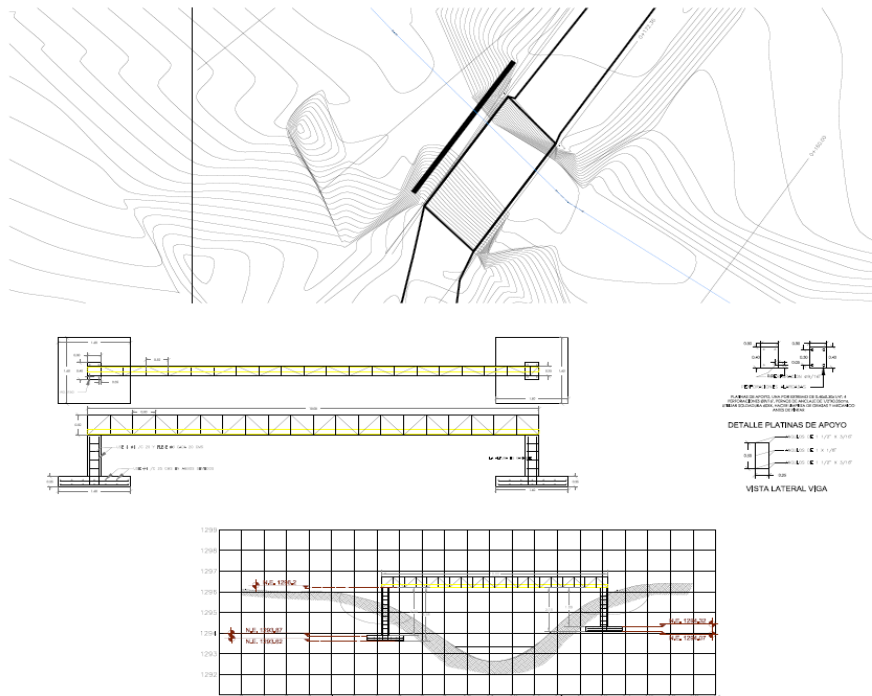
Esquema de obra Hidráulica Propuesta, paso elevado tipo cercha quebrada La Chiquita.
